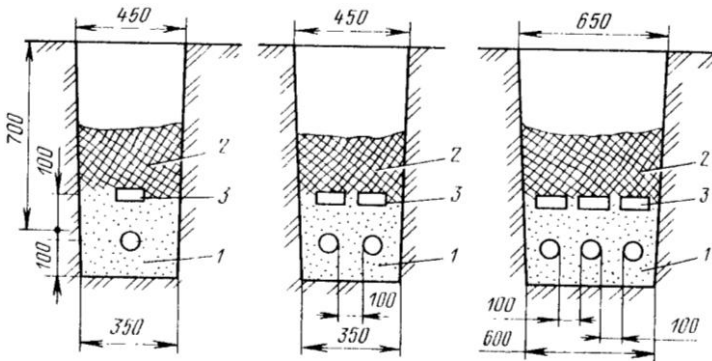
Переріз траншеї для прокладки кабелю напругою до 10 кВ:
